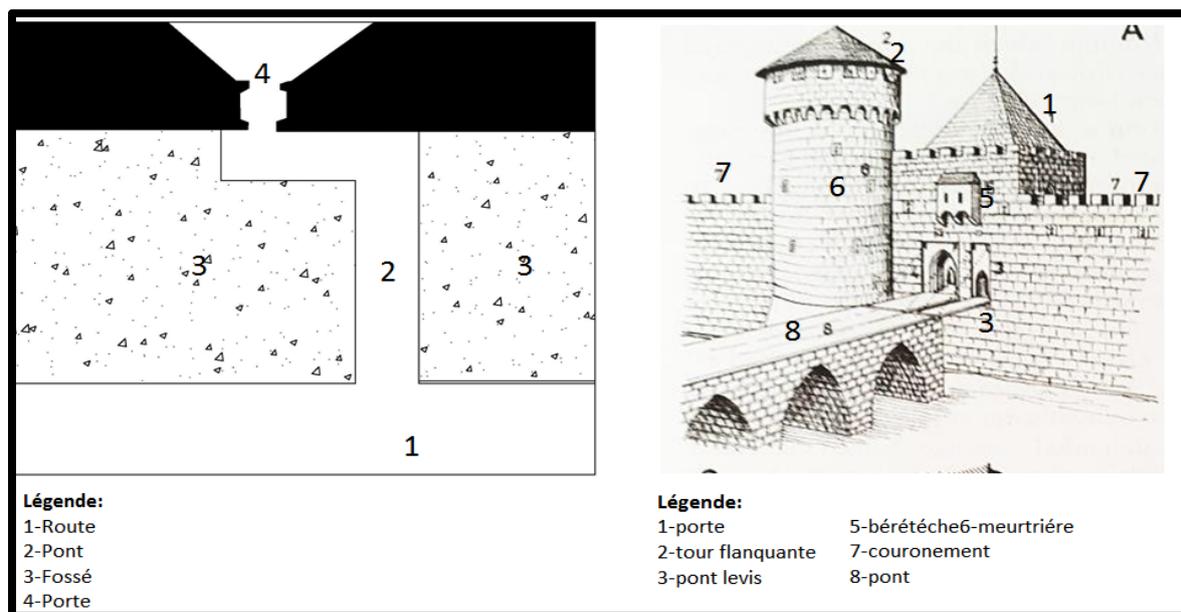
vue en plan et en élévation d'une porte équipée d'un pont- levis
